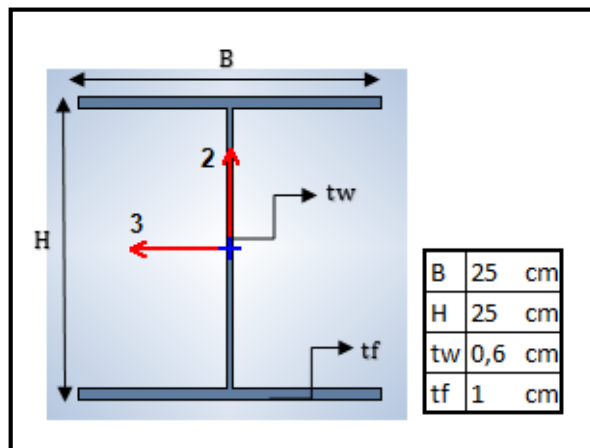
Dimensiones, Columna 3 con pórticos resistentes a momento.
